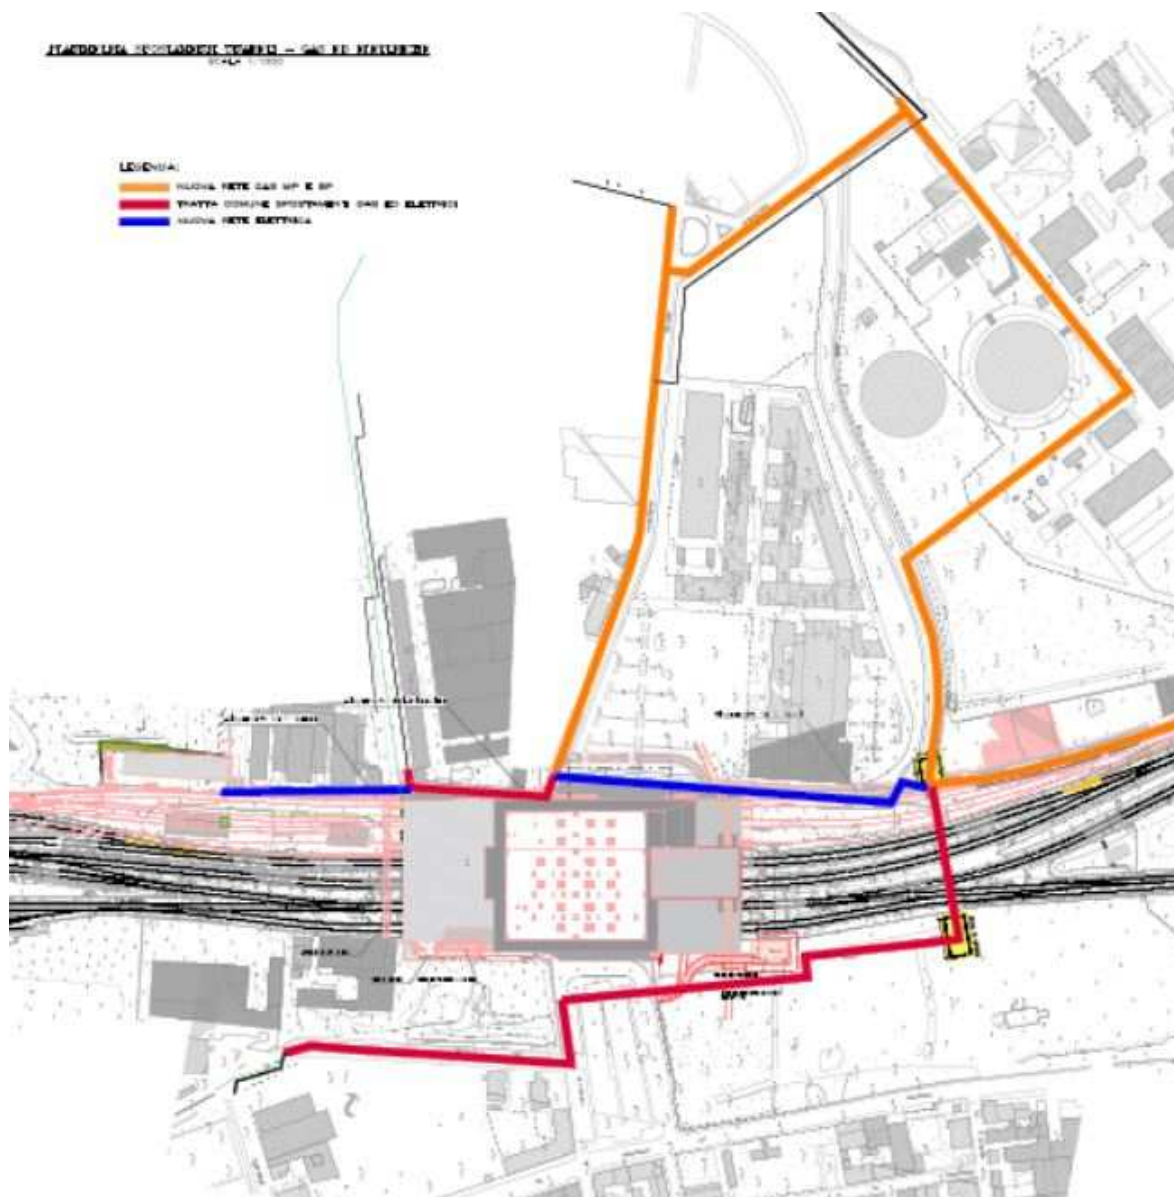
Stralcio schematico passaggio nuovi impianti UNARETI gas ed elettrici zona Bovisa
